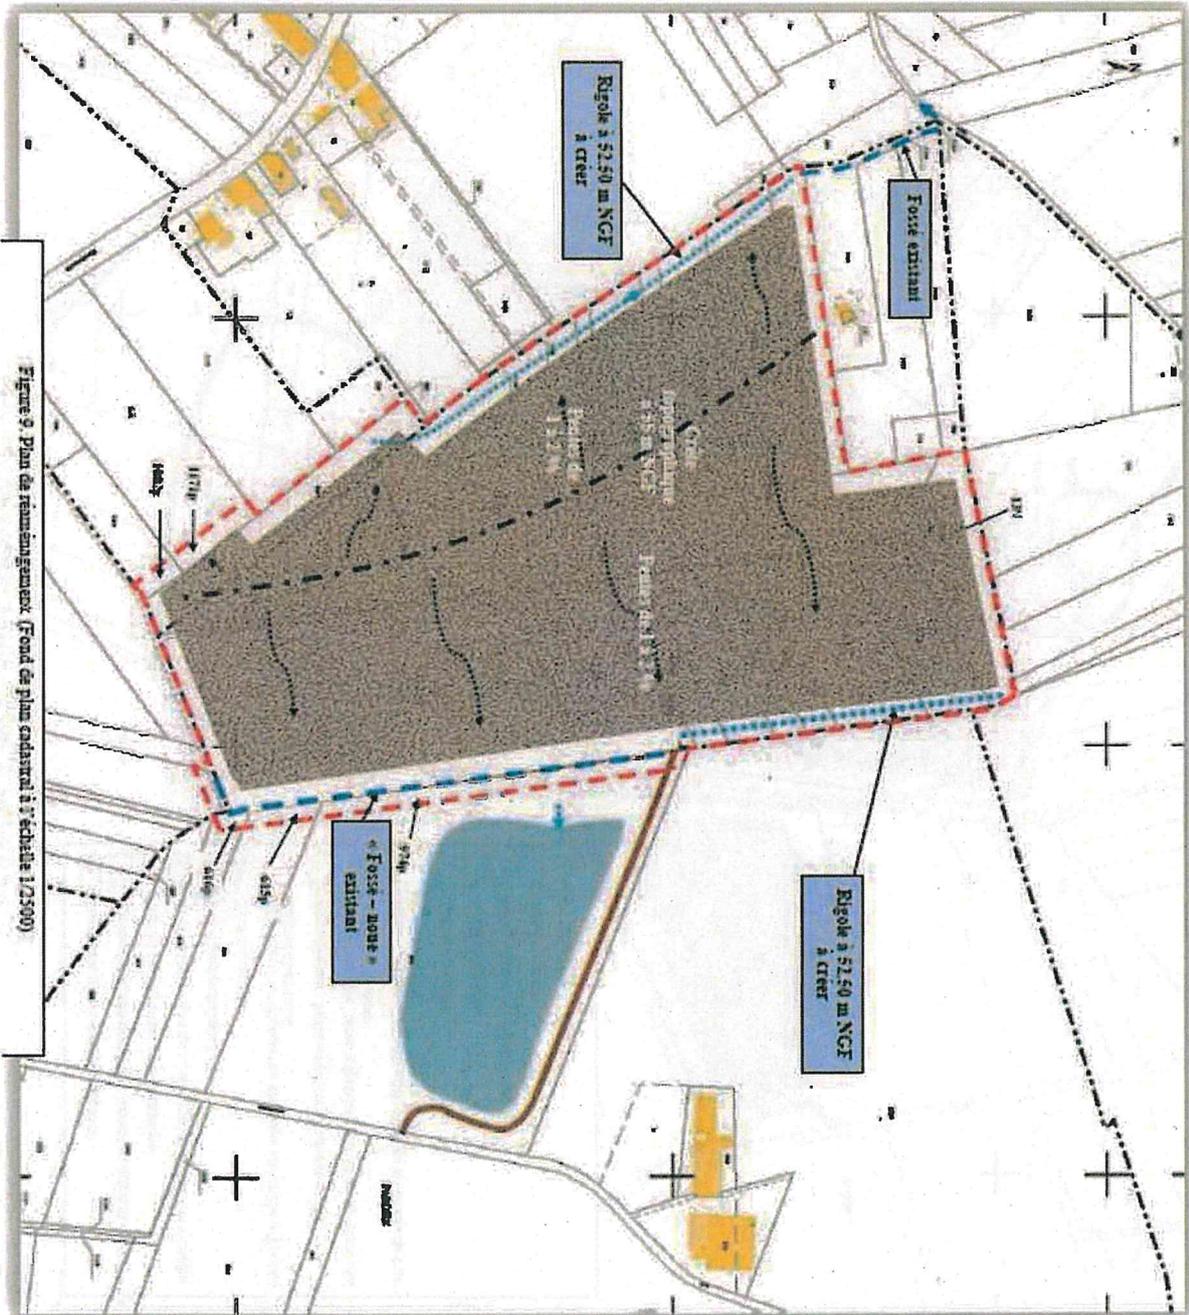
Plan de réaménagement (Fond de plan cadastral à l'échelle 1:2500)
